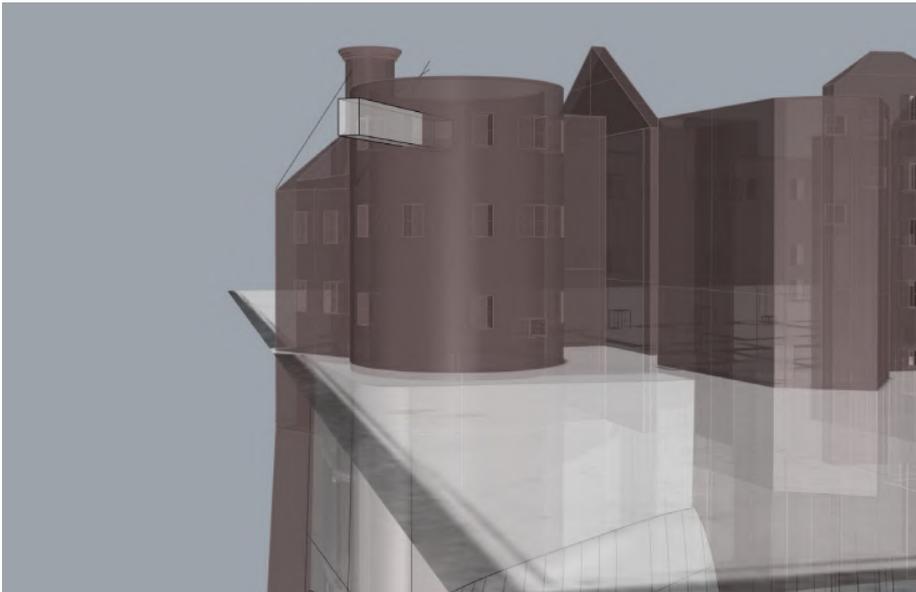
Plan de coupe Rhino du plan du premier étage du château avec retraçage des bâtiments
